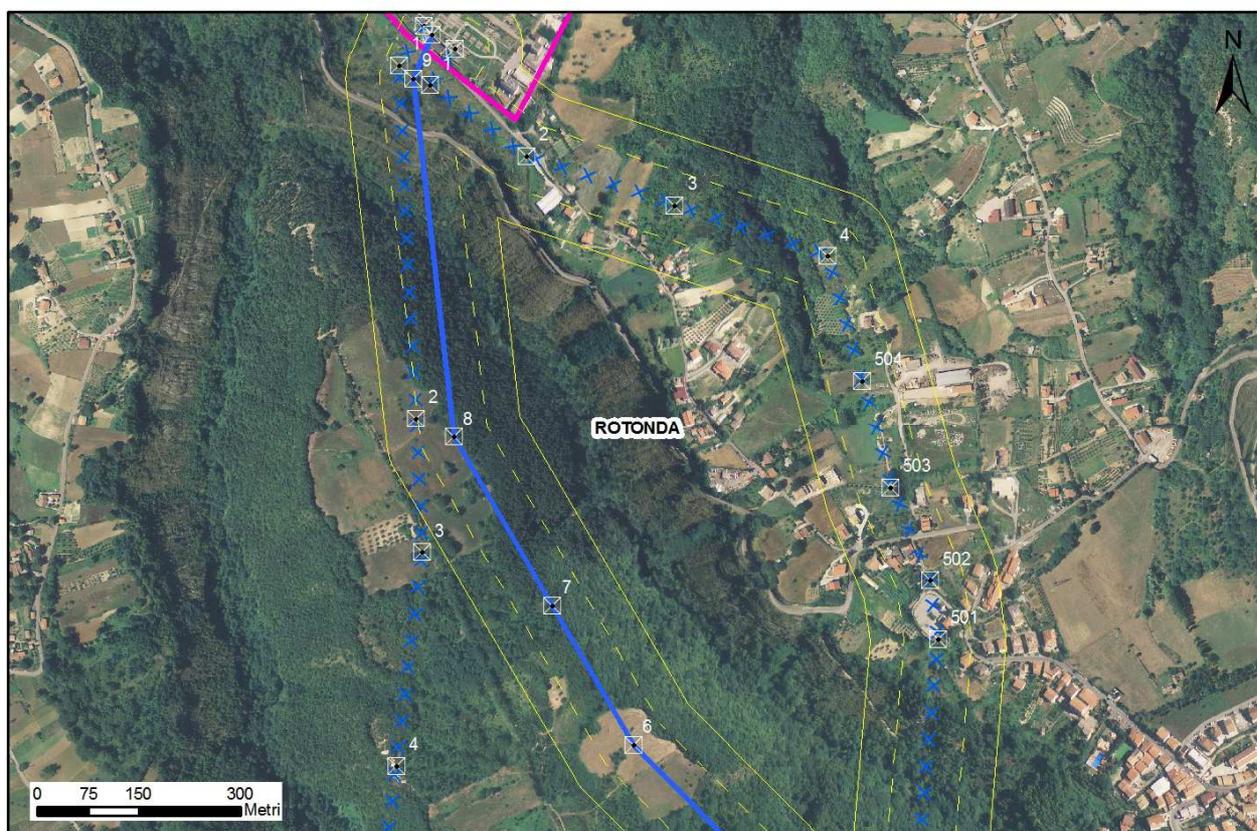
Demolizione linea a 150 kV "Rotonda - Castrovillari" e realizzazione nuova linea a 150 kV in variante alla "Rotonda – Mucone All." – Comune di Rotonda
